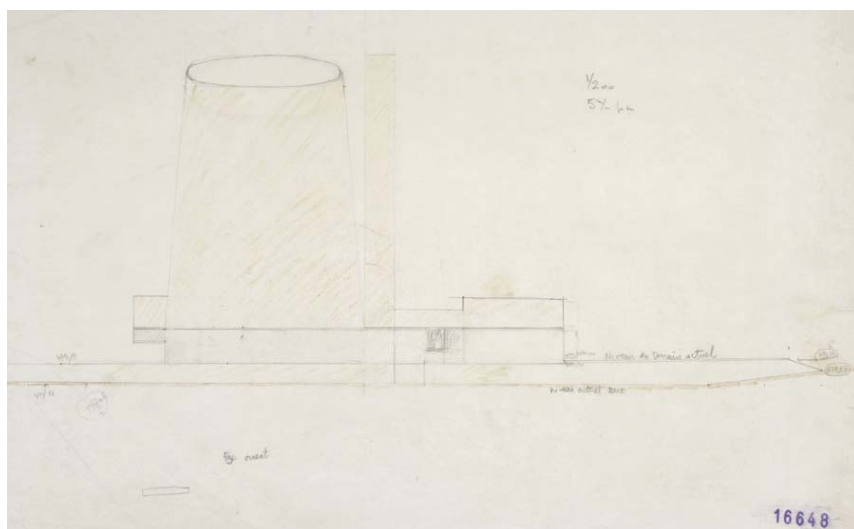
Dibujo variante de la fachada oeste. Primera versión. Fuente: FLC. 16648
